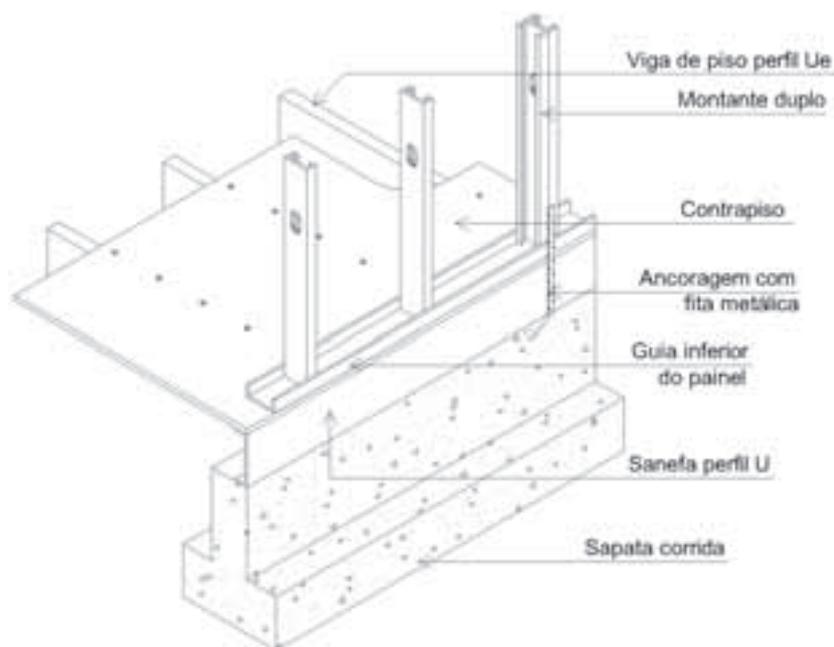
Corte detalhado de fundação tipo sapata corrida
